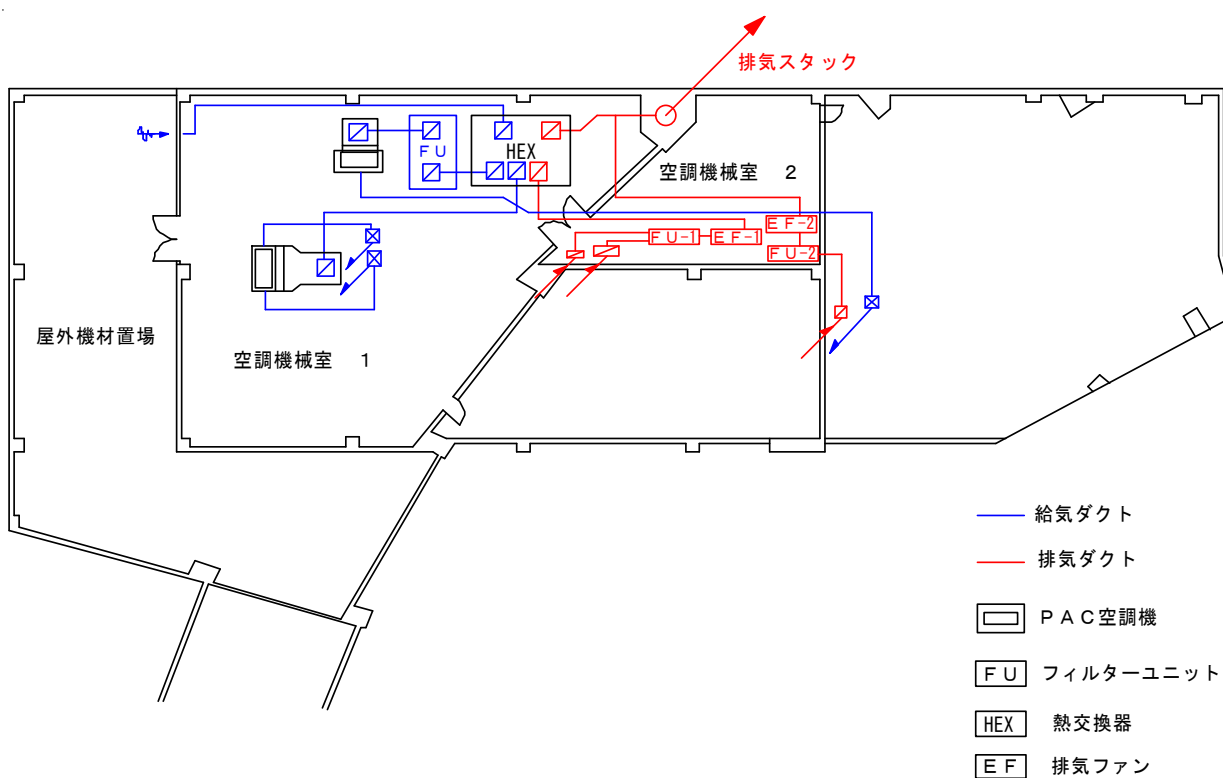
放射光アイソトープ実験施設の空調・排気設備 2階平面図(変更なし)
